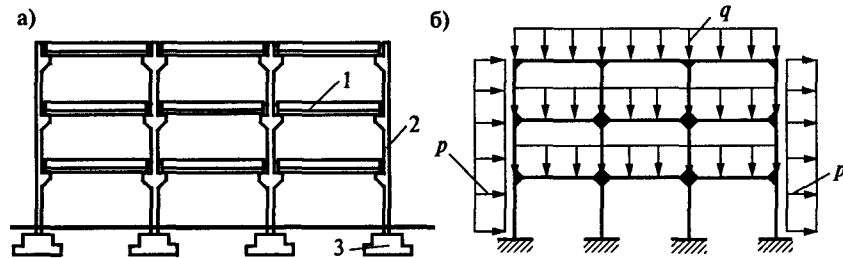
Рамная схема каркаса: а) конструктивная схема; б) расчетная схема; 1 — неразрезанный ригель; 2 — колонна; 3 — фундамент
